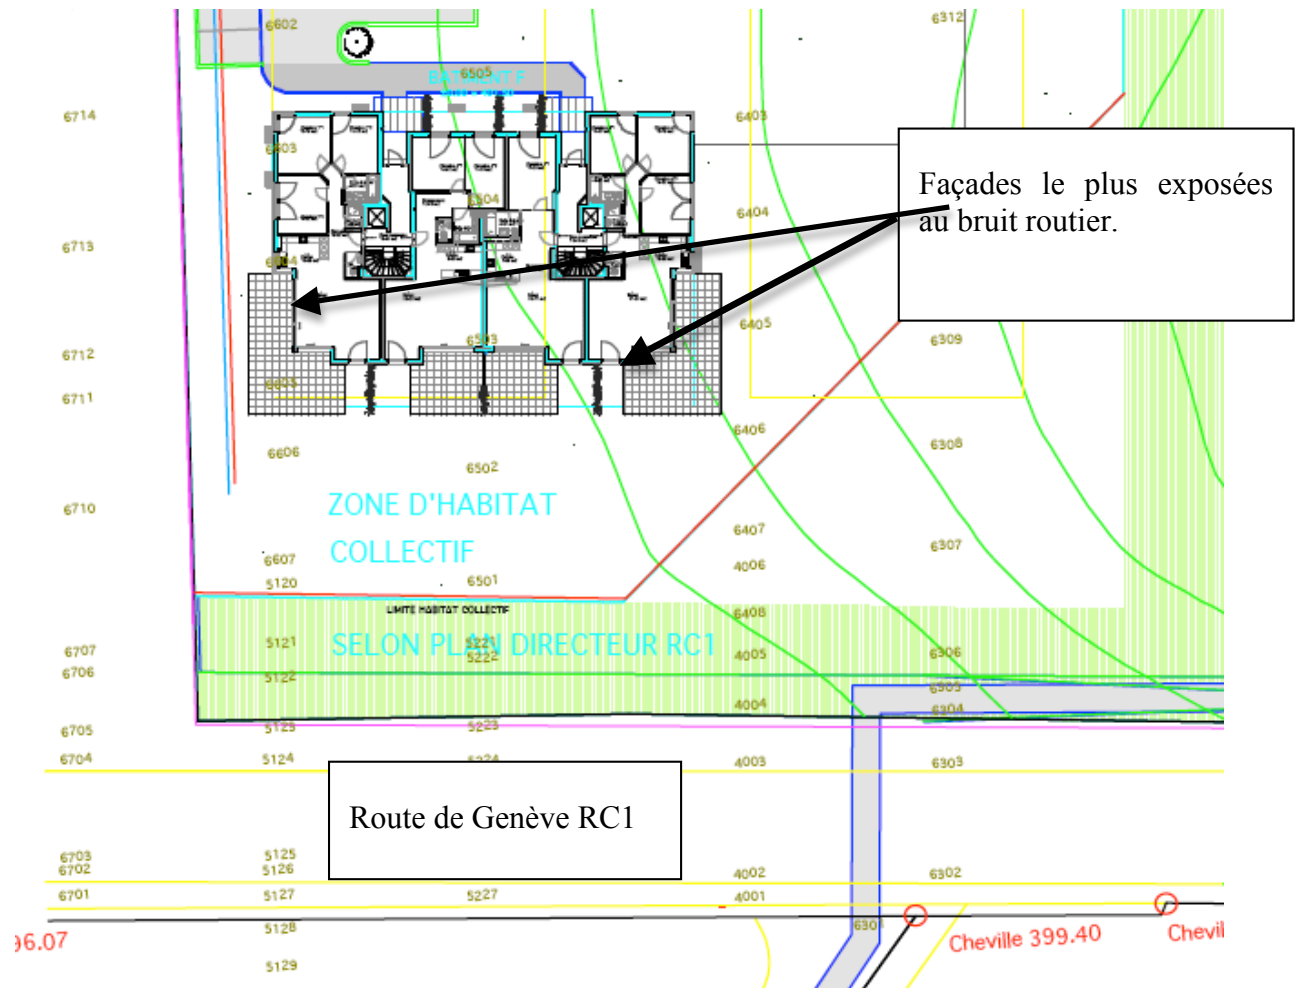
plan de situation général du bâtiment exposé au bruit de la RC1
